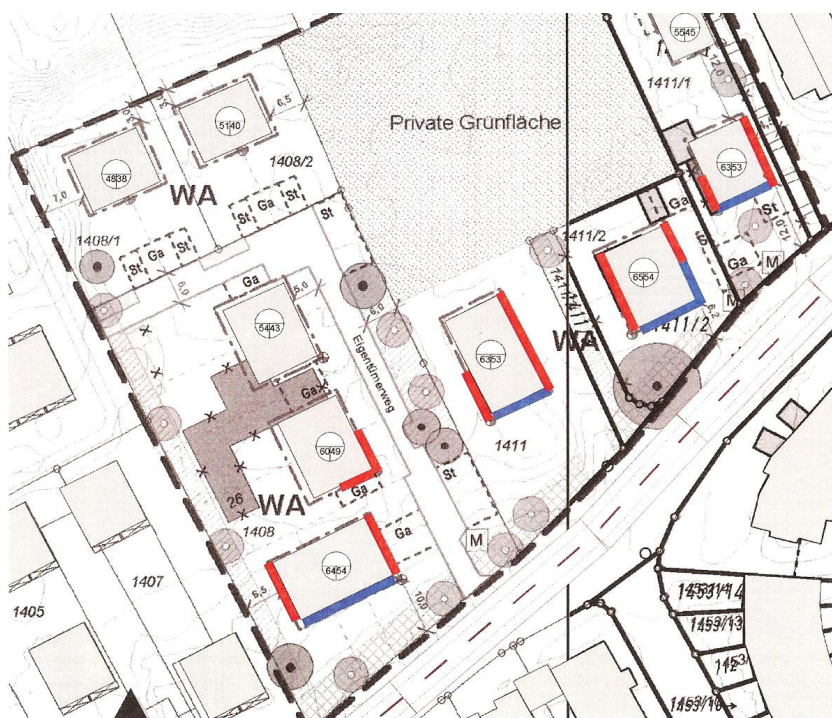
Detailplan Immissionsschutzfestsetzung
